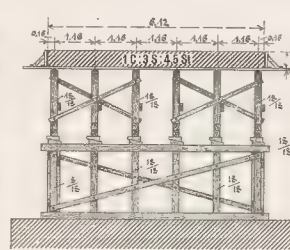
Schnitt durch das Lehr-Gerüst des Haupt-Gewölbes. M. 1:150
